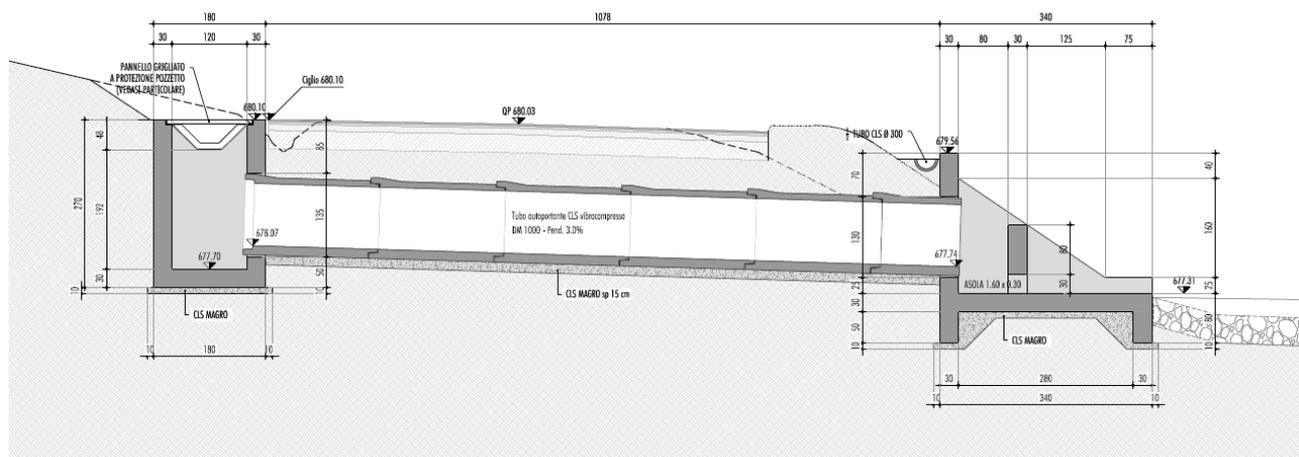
ATTRAVERSAMENTO IDRAULICO TIPO
